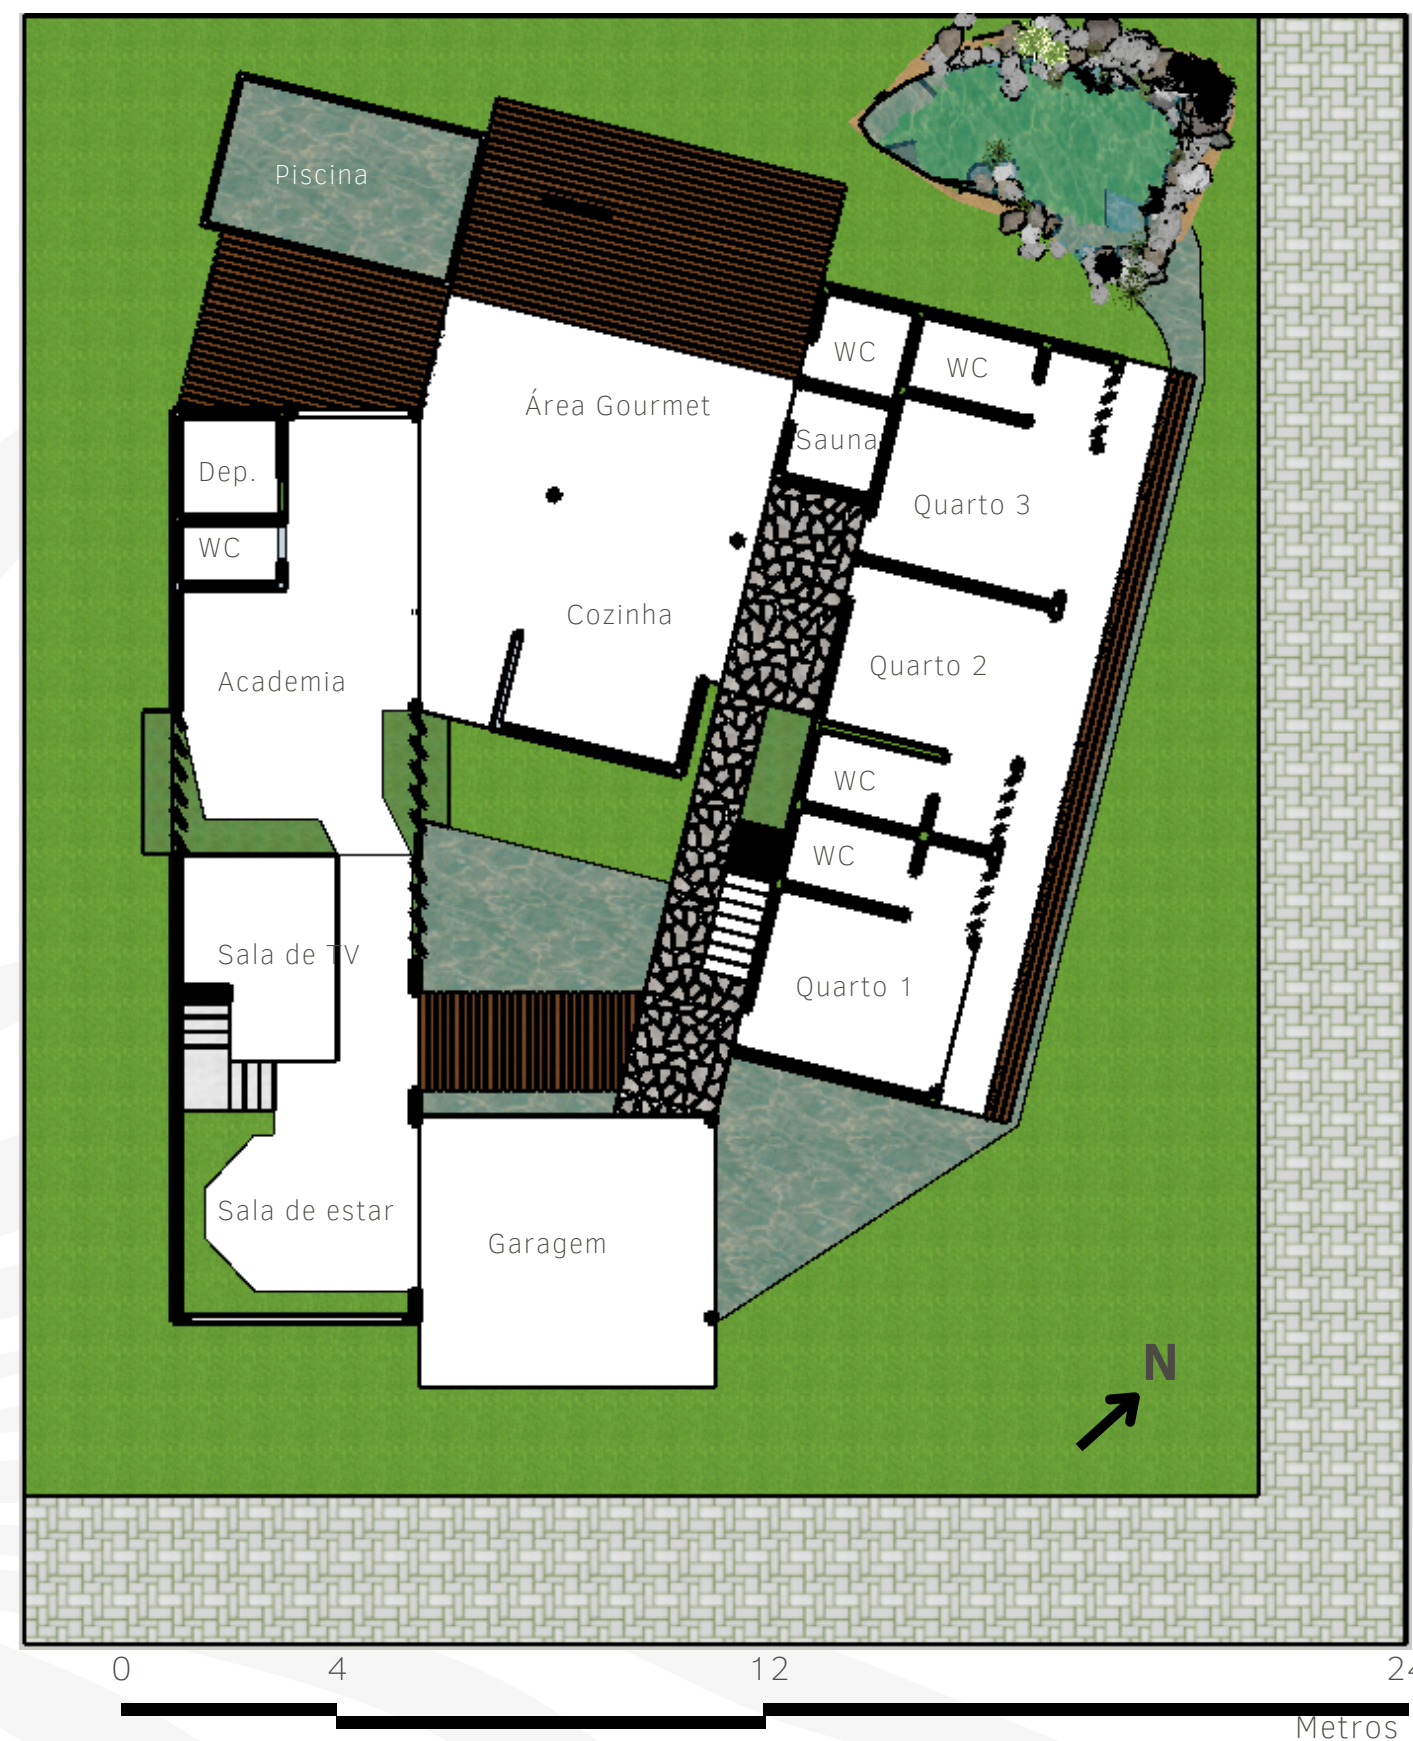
Planta baixa térrea da proposta. Fonte: Elaboração própria da autora.
